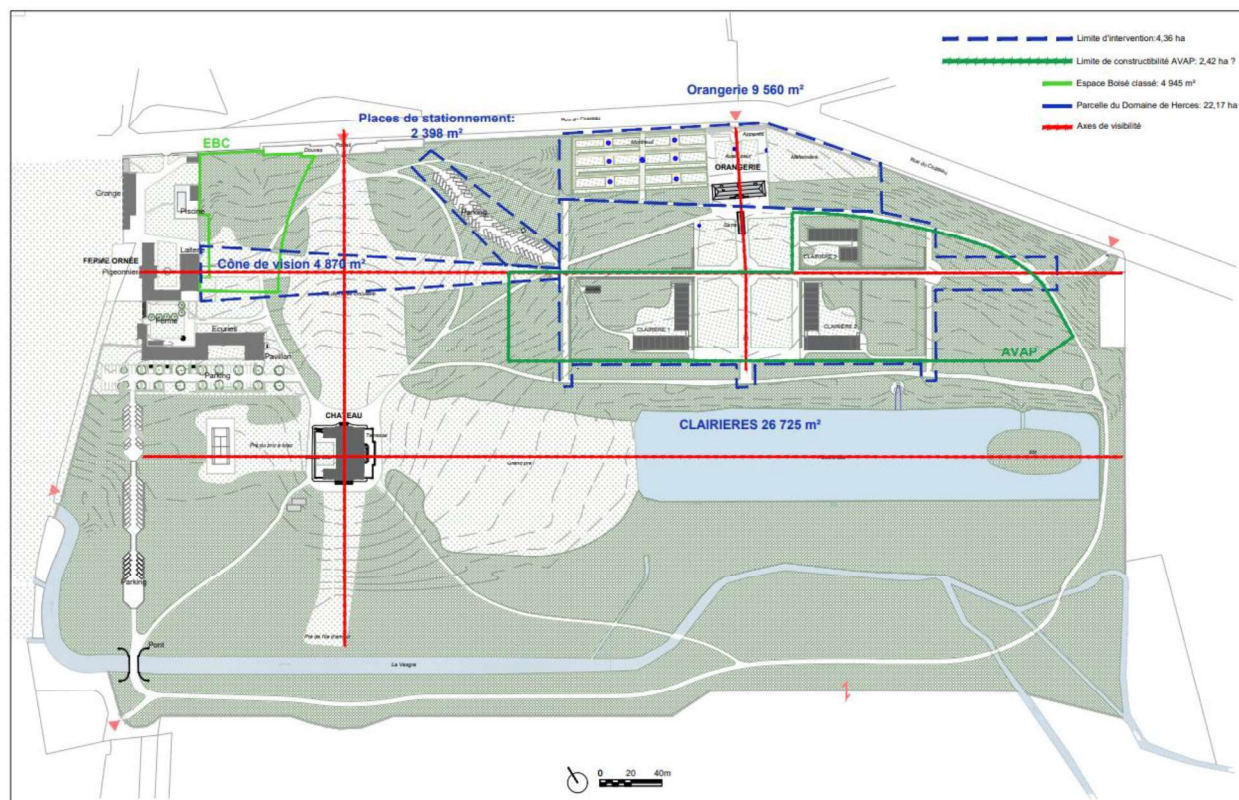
Plan masse prévisionnel du projet (Source : AAA Béchu)
